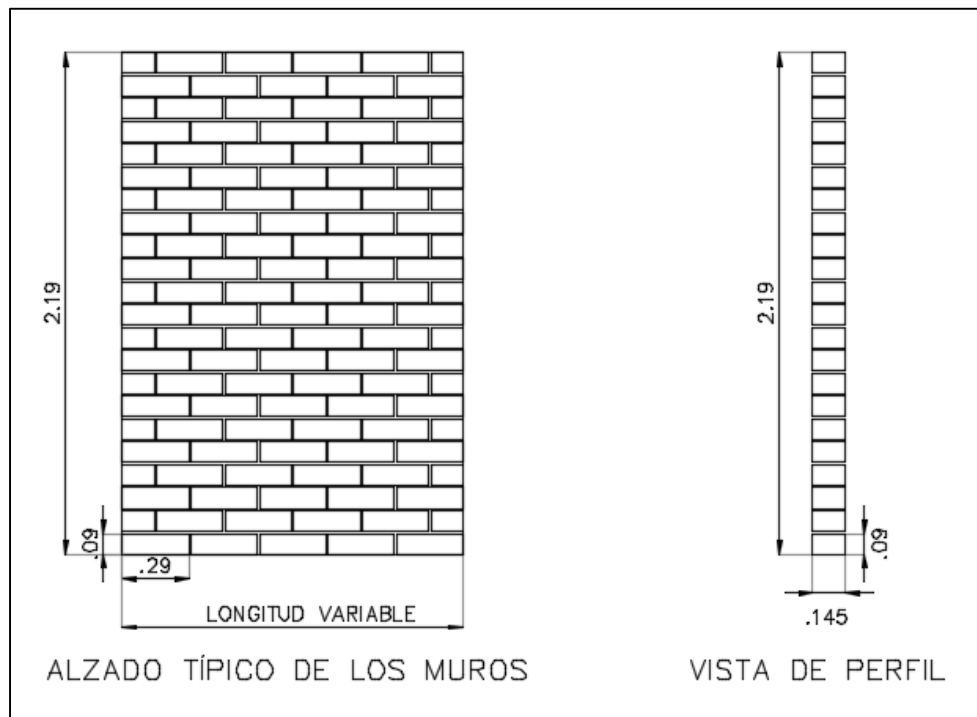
Configuración de muros, dimensiones y refuerzo. Fuente: el autor
